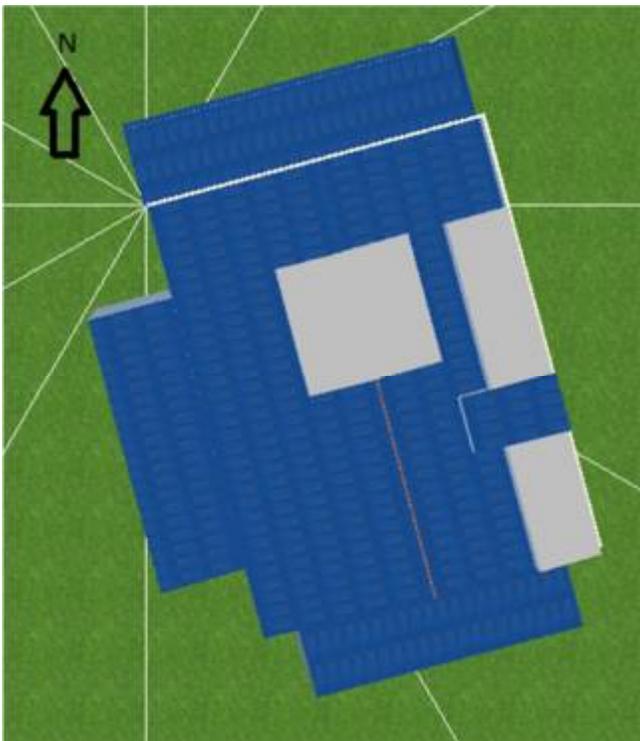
Plano de la techumbre. Fuente: gendarmería.
